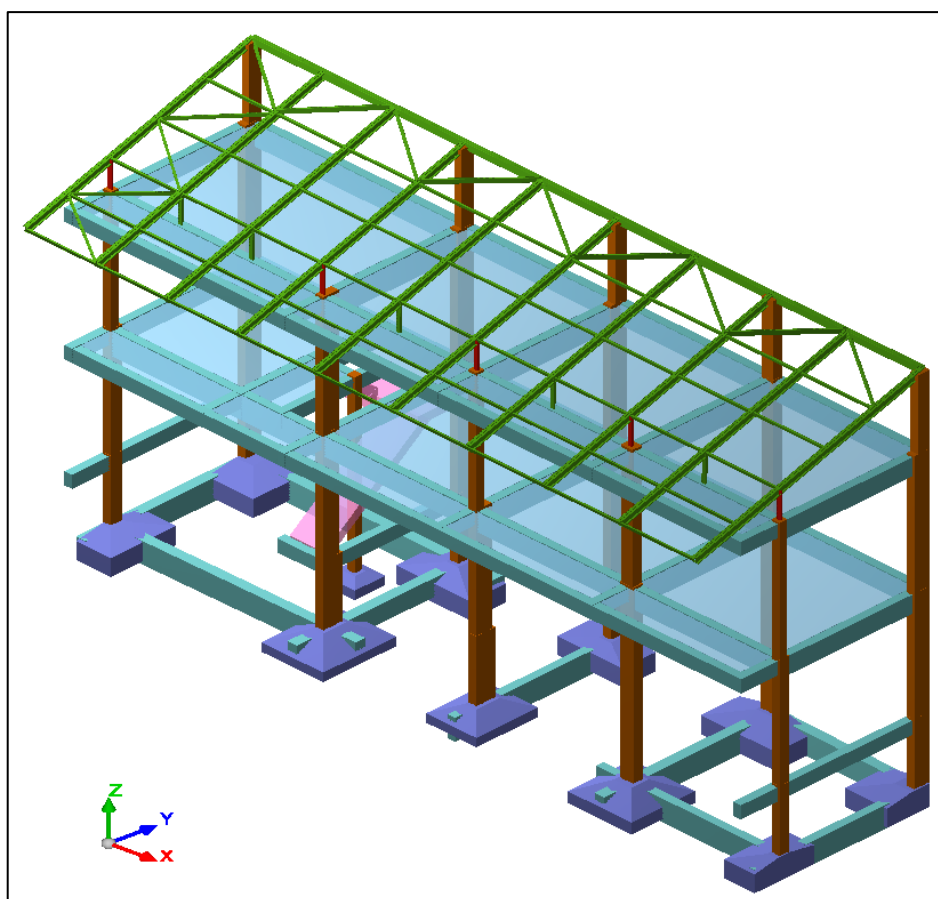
Visualização 3D da estrutura – alternativa em concreto.
